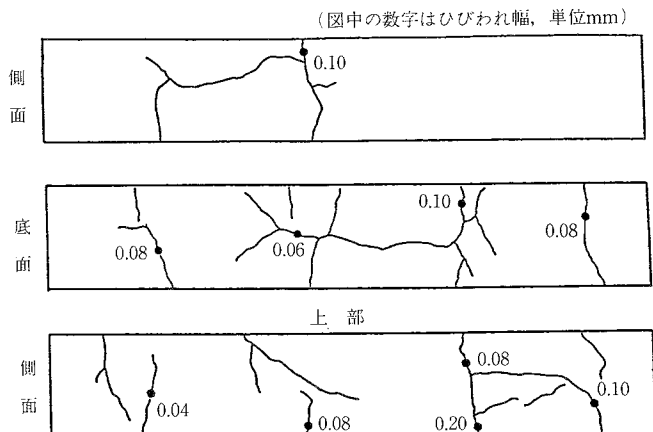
コンクリート角柱体に生じたひびわれ (ガラス質安山岩使用, W/C=50%, R<sub>2</sub>O=1.46%)
